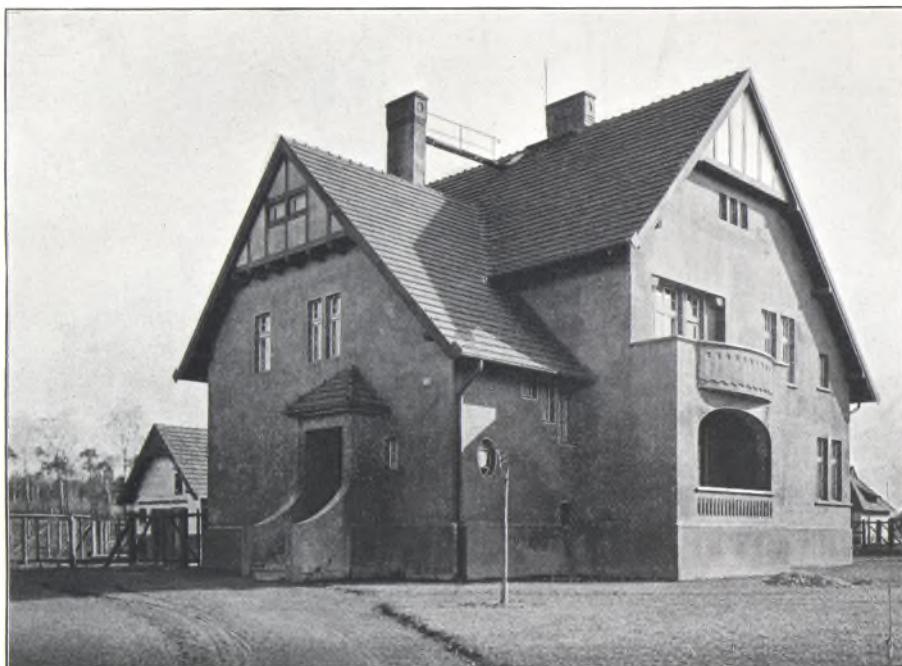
Beamtenkolonie der Oheimgrube. Wohnhaus.
